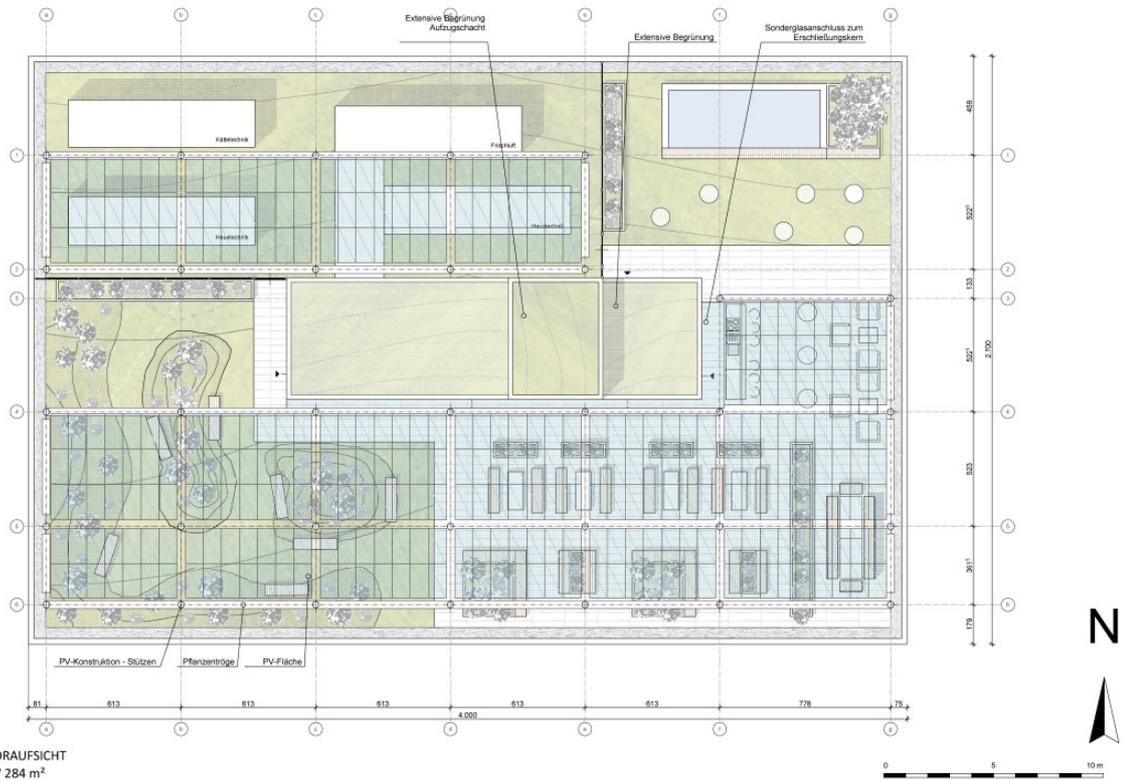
Mustergrundriss für einen PV-Dachgarten auf einem Bürogebäude (Quelle: IKI Ag Ress. Bauen, BOKU Wien).
